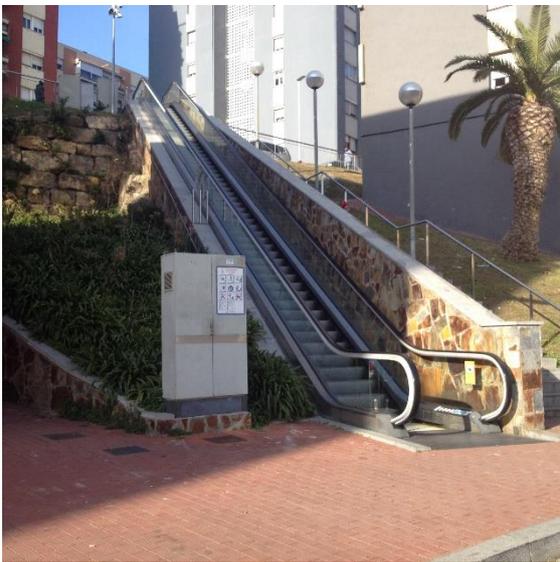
Imagen escalera mecánica junto a muros de contención revestidos en piedra y pavimento rojo como elementos que dan unidad formal al barrio.
